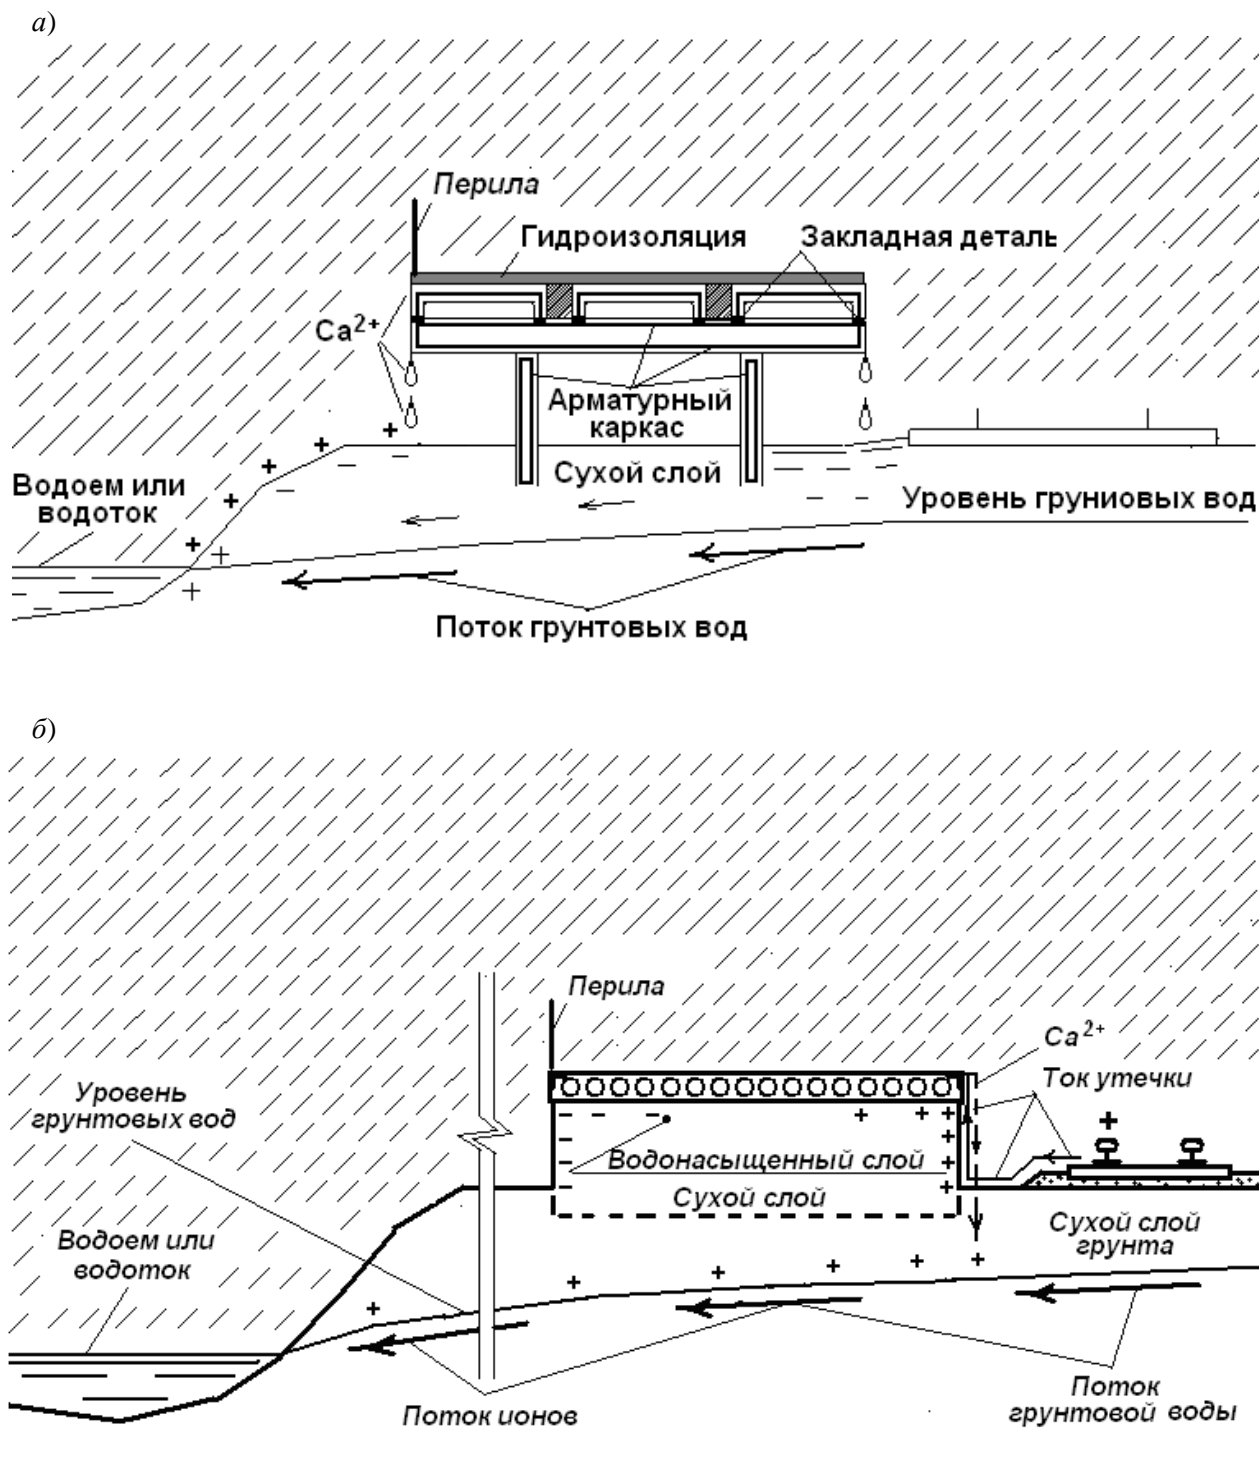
Схема протекания тока утечки с рельсов в конструкции высокой пассажирской платформы с бетонными опорами (а) и с железобетонными стойками и ригелями (б)
